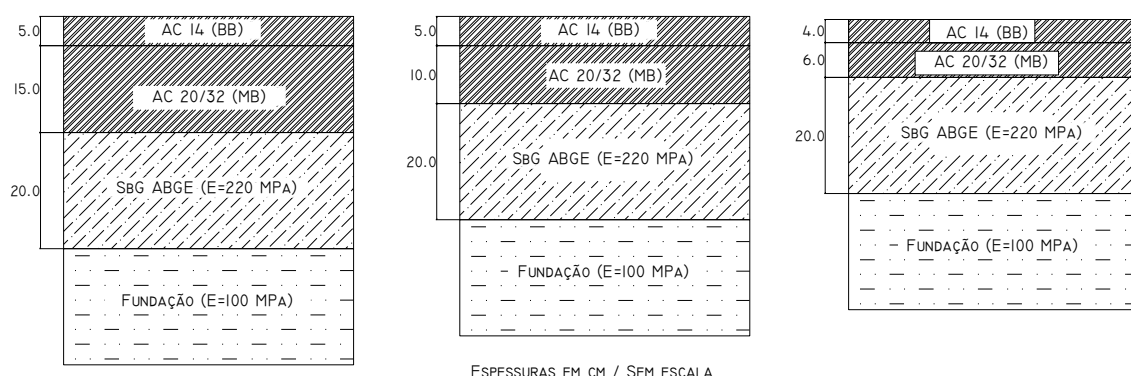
Estruturas de pavimento com espessuras de misturas betuminosas de 200 mm (esq.), 150 mm (centro) e 100 mm (dir.)
